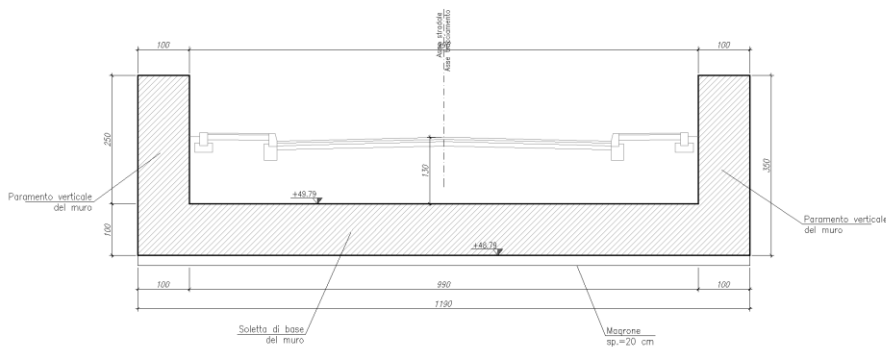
Muro ad “U” lato ovest: Sezione trasversale alla pk 25.50
